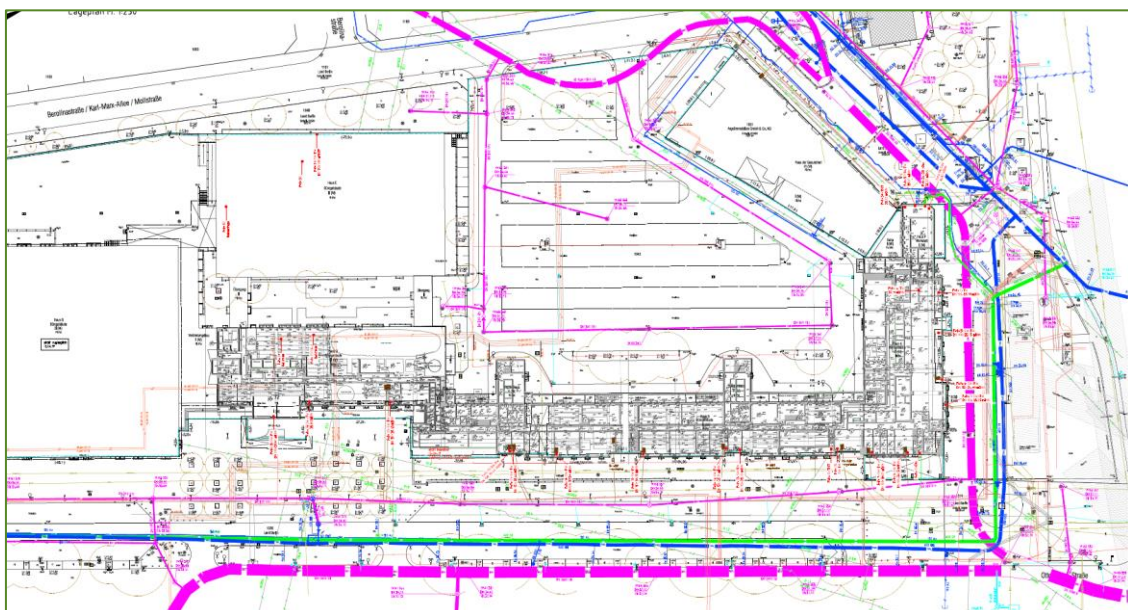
Leitungsplan und Grundrissplan von den Bestandsgebäuden.
